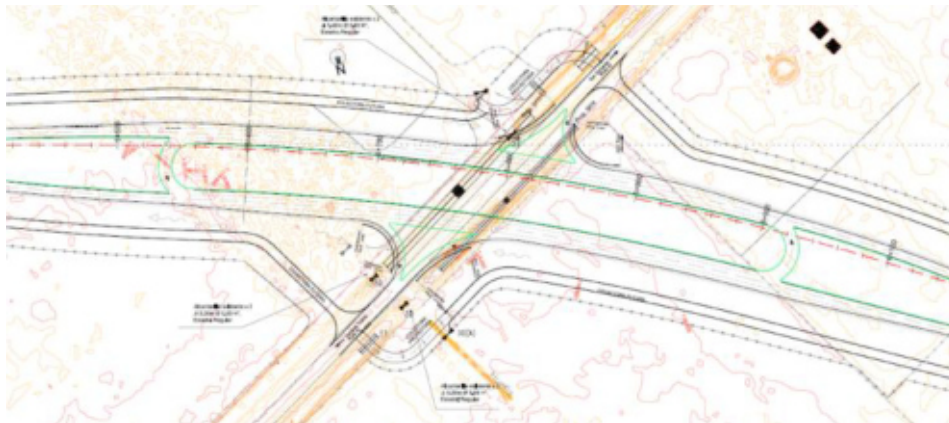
Alternativas Analizadas para la Variante Venado Tuerto
